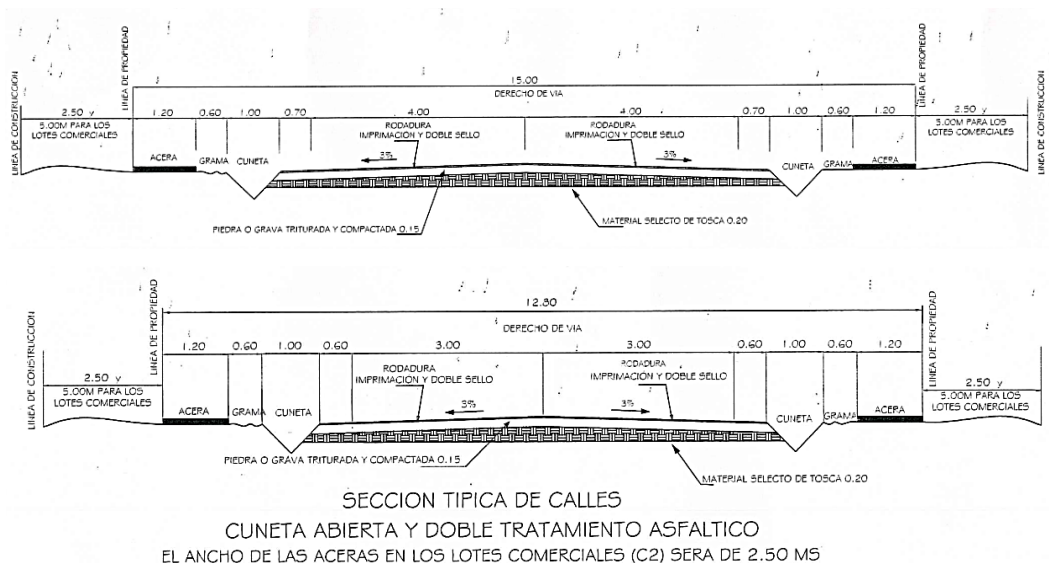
Esquema de las calles de 15 m y 12.80 m de ancho. (Fuente: Anteproyecto)
